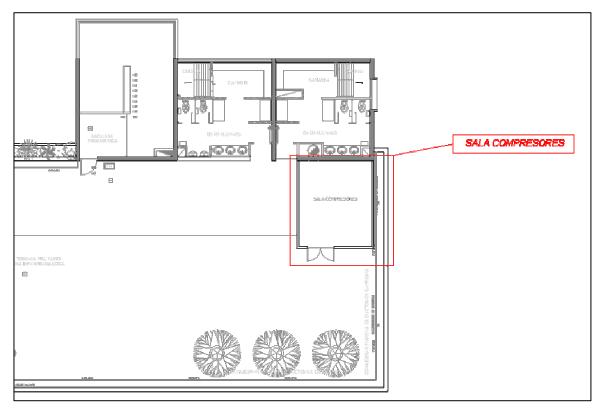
PLANTA ARQUITECTURA OCTAVO PISO (AZOTEA).
